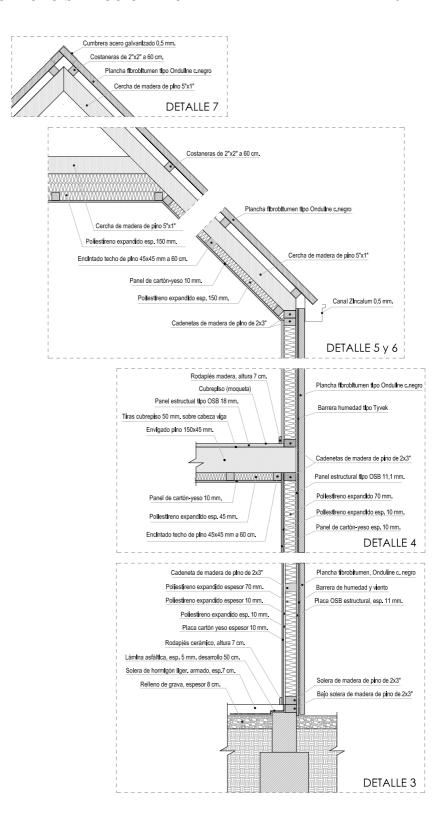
Detalles 3 a 7. Sección constructiva por cerramiento de fachada.
